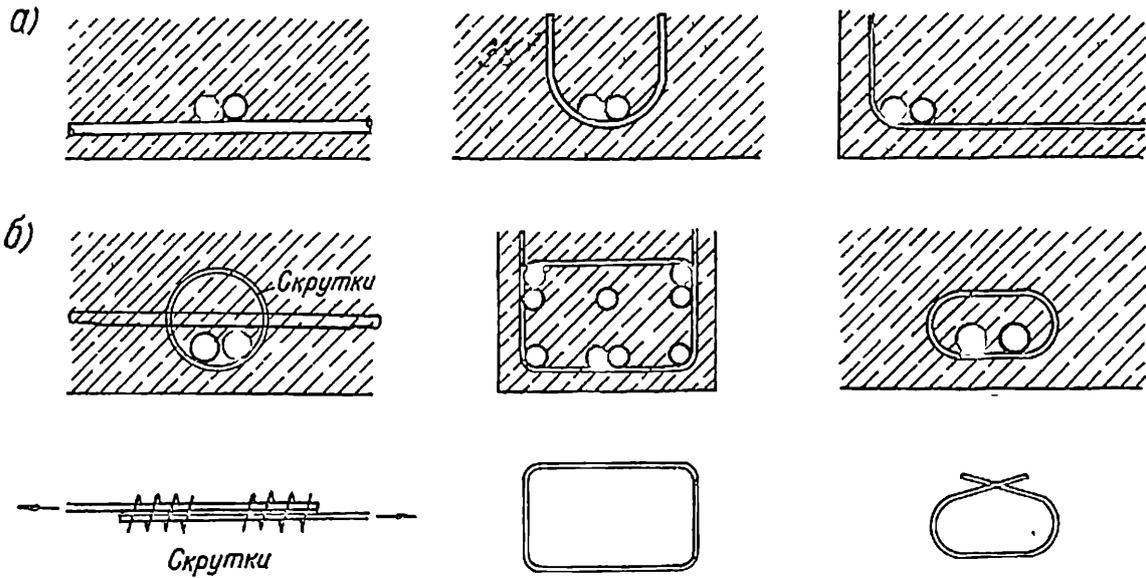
7. Возможные конфигурации поперечной арматуры в стыках
